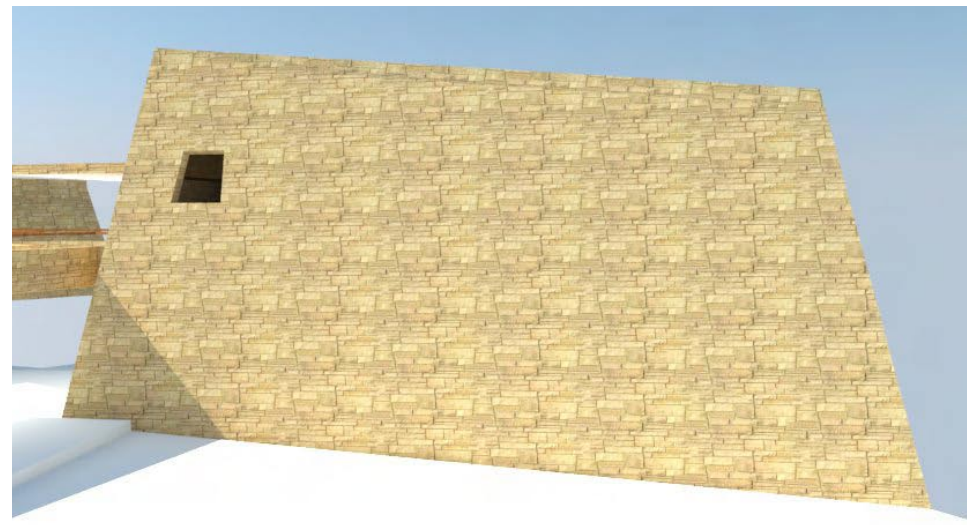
Plantas y Fachadas del Auditorio para evaluar la Norma
